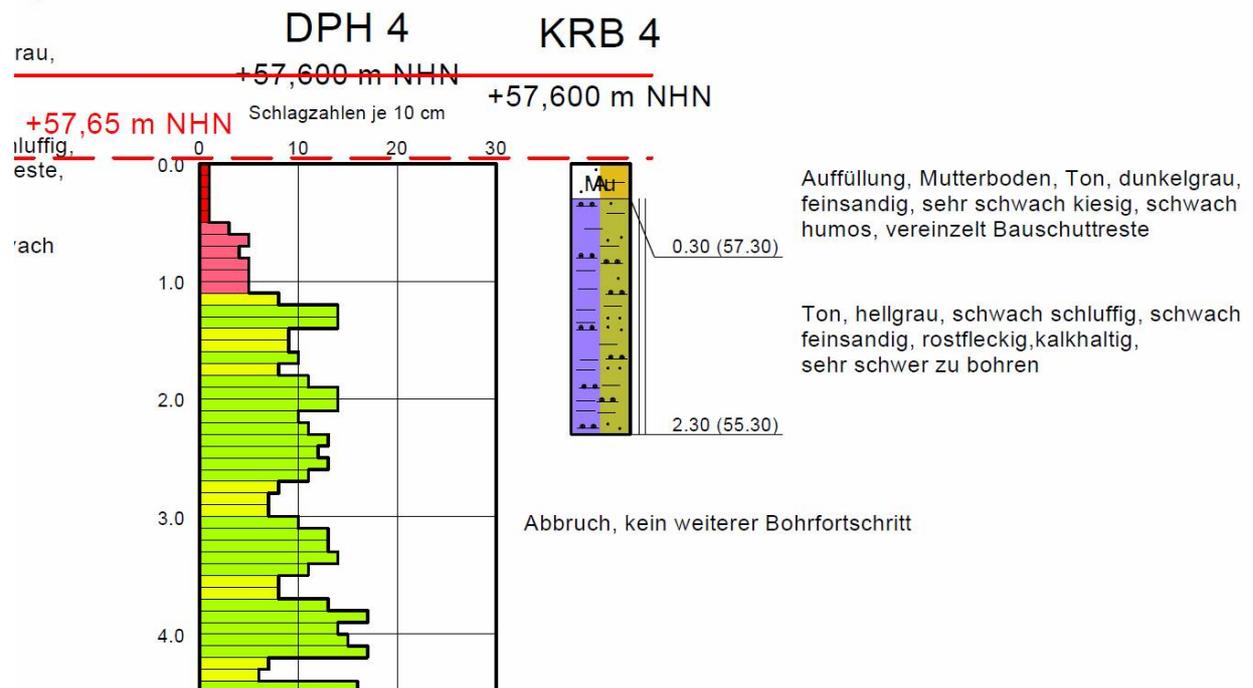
Bohrung Südwestecke der Halle, mit am nächsten zur Einleitungsstelle
